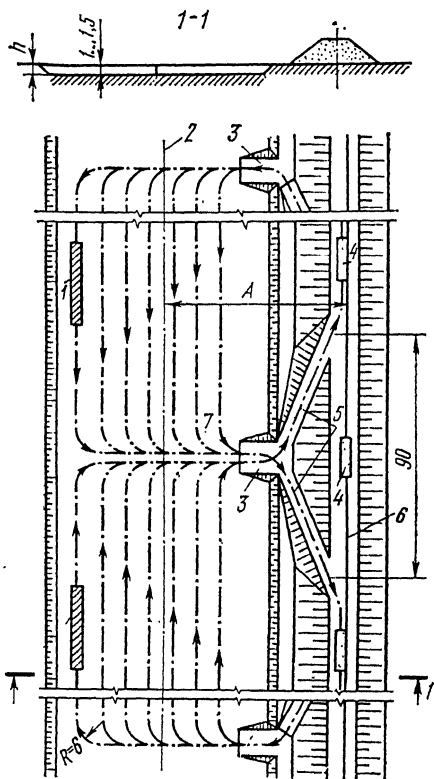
Возведение насыпи из бокового резерва скрепером при движении его по схеме восьмерка (размеры в м):
